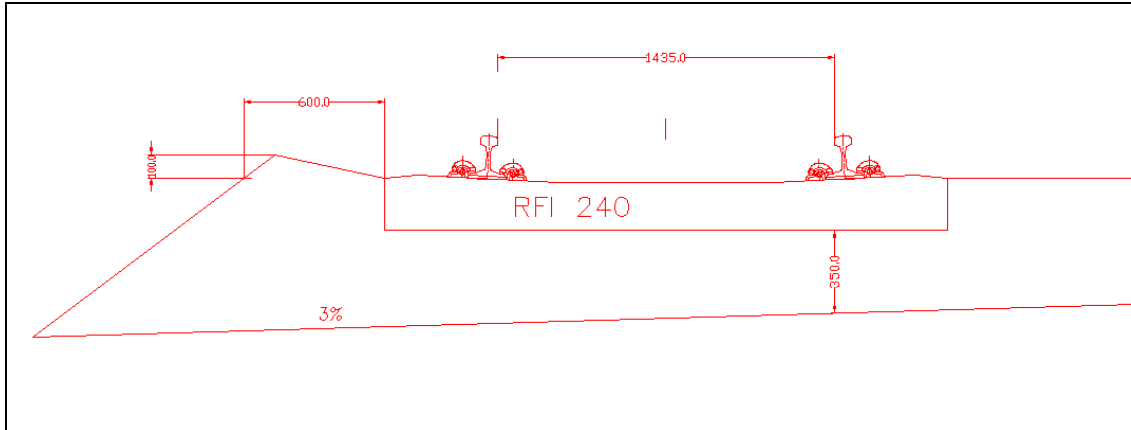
Sezione tipo di armamento a doppio binario con traversa RFI 240.
